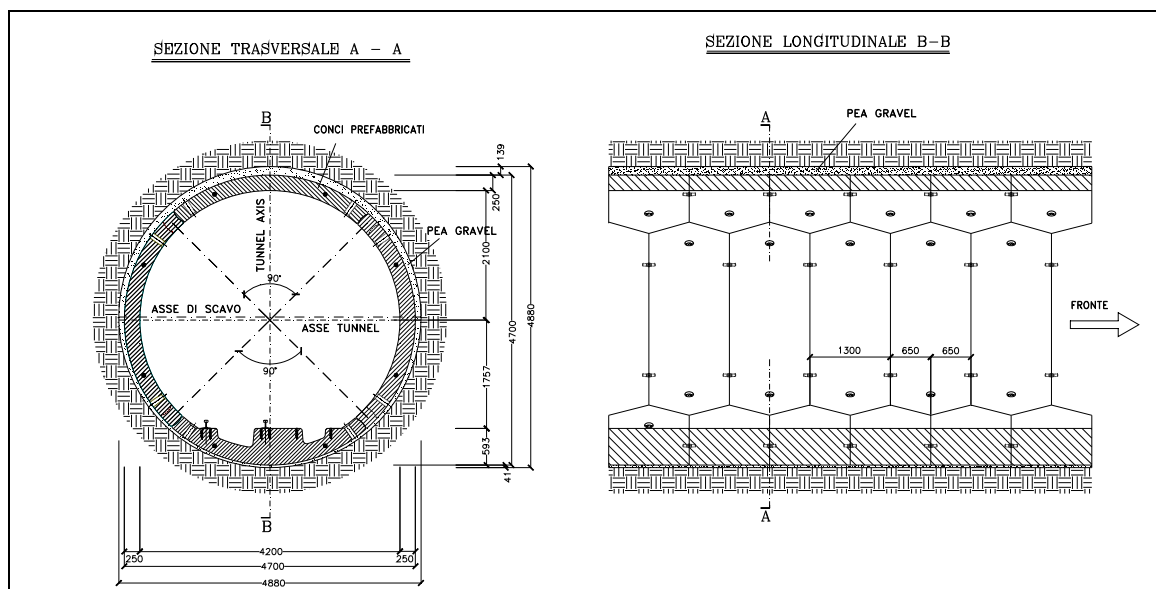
Sistema di conci prefabbricati - Sezioni tipo trasversale e longitudinale
